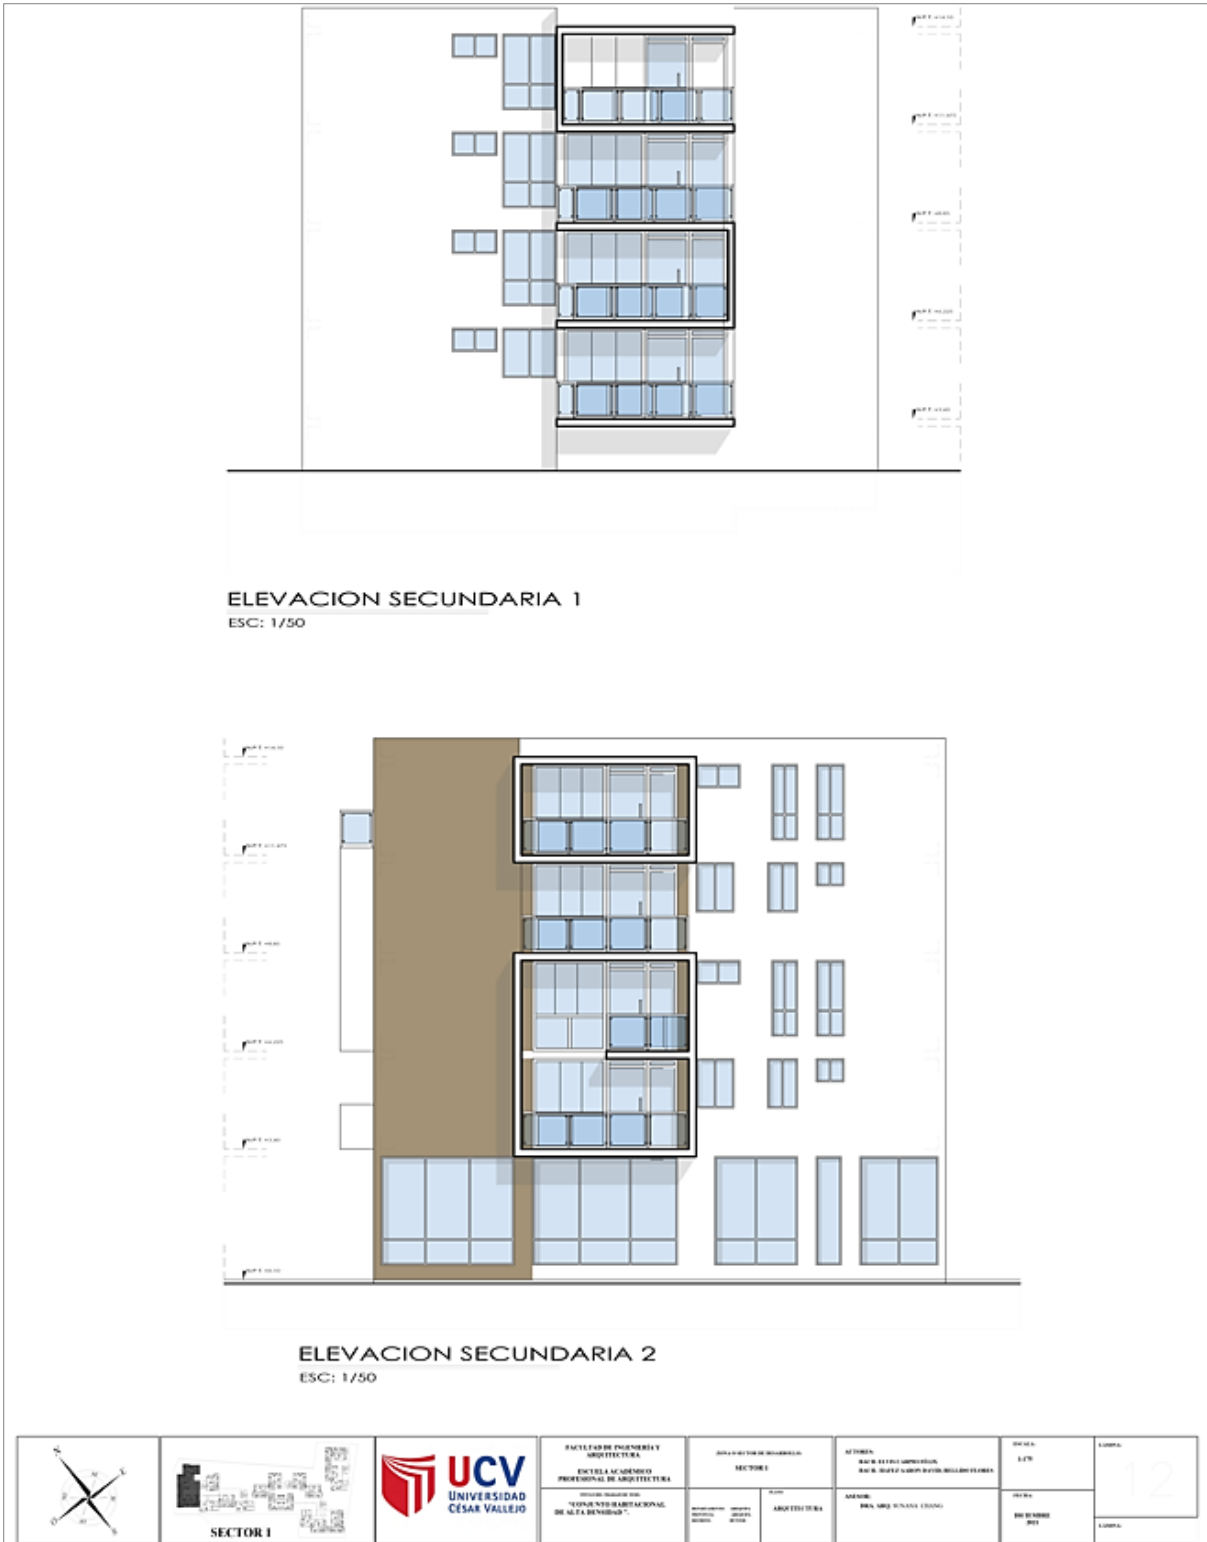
Planos de Arquitectura – 12 – Bloque 1 – Elevaciones Secundarias
